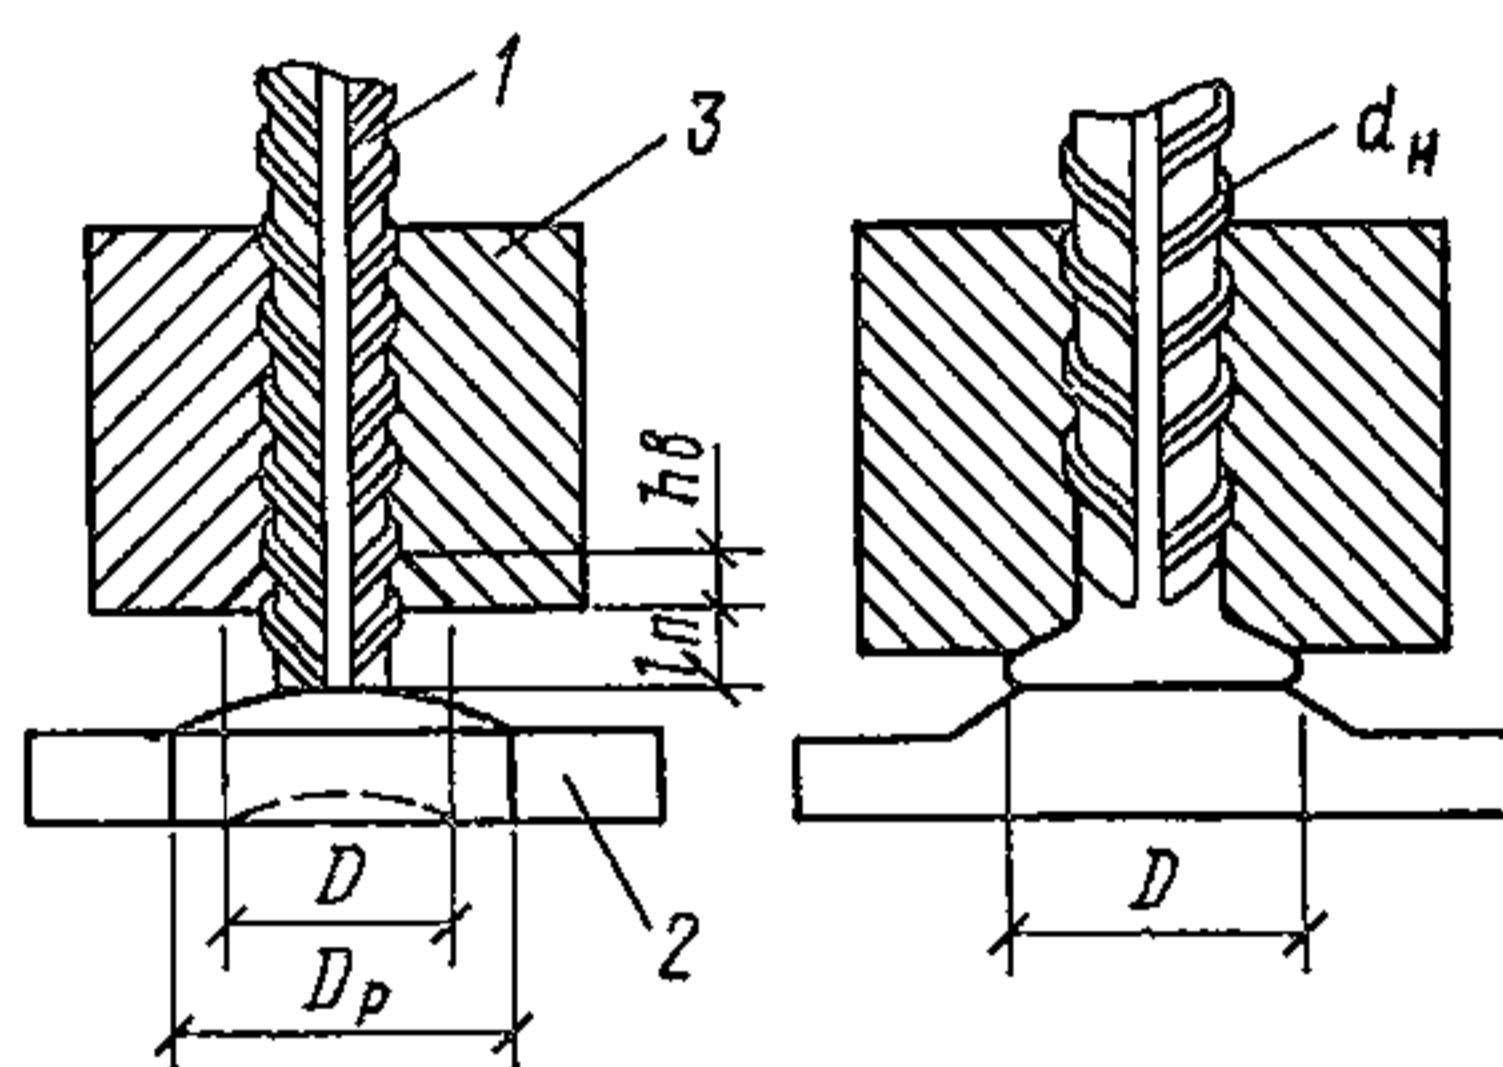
Конструкция таврового соединения, выполняемого контактной рельефной сваркой
